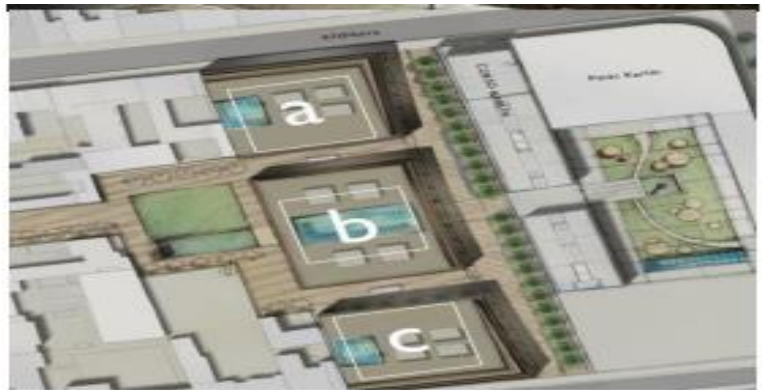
PLAN DE MASSE SOURCE : ARCHIDAILY
